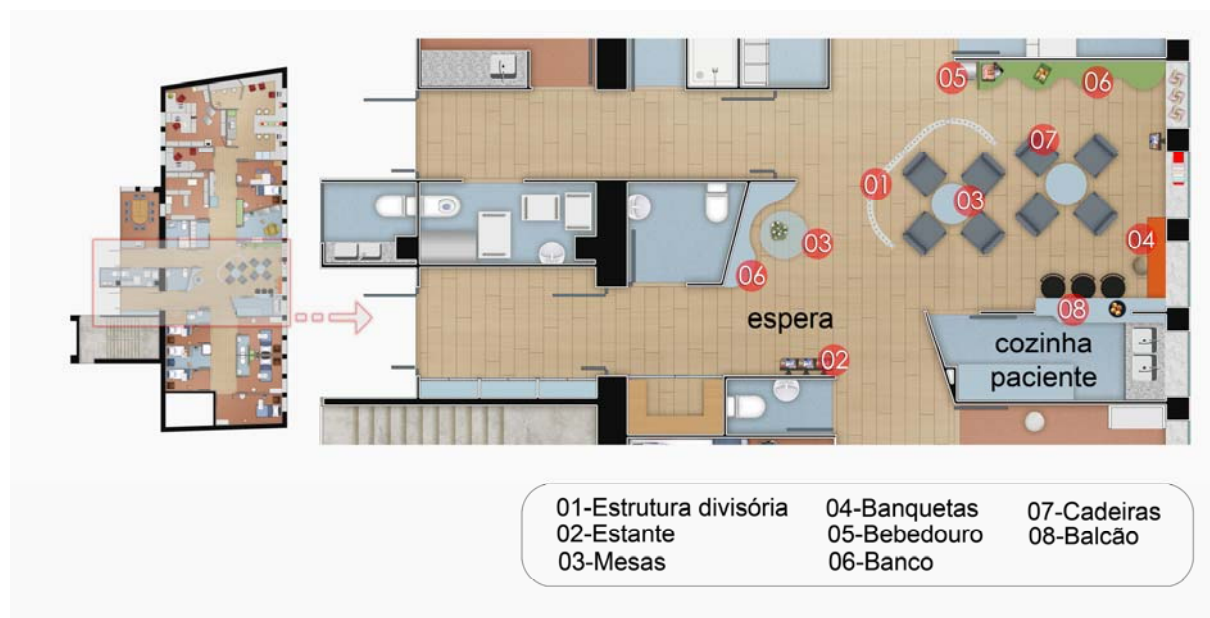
Plantas de implantação e configuração da sala de espera – posterior ao projeto
